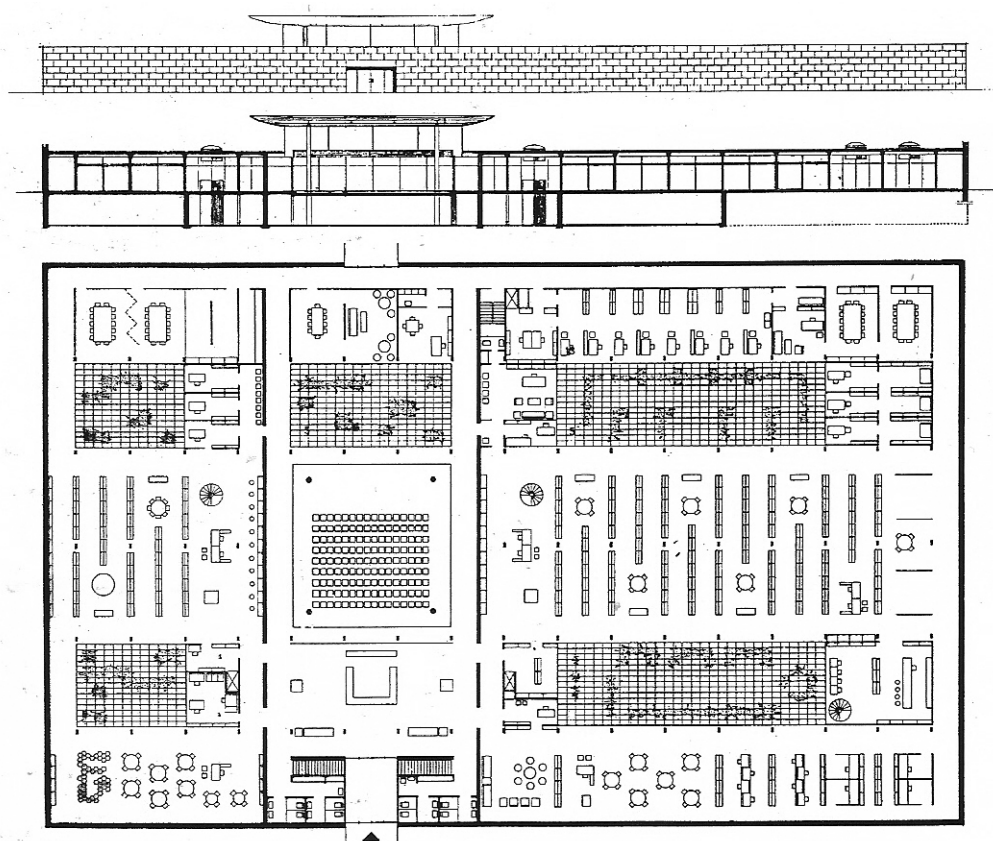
Planta, corte e alçado da Biblioteca de Rødovre
